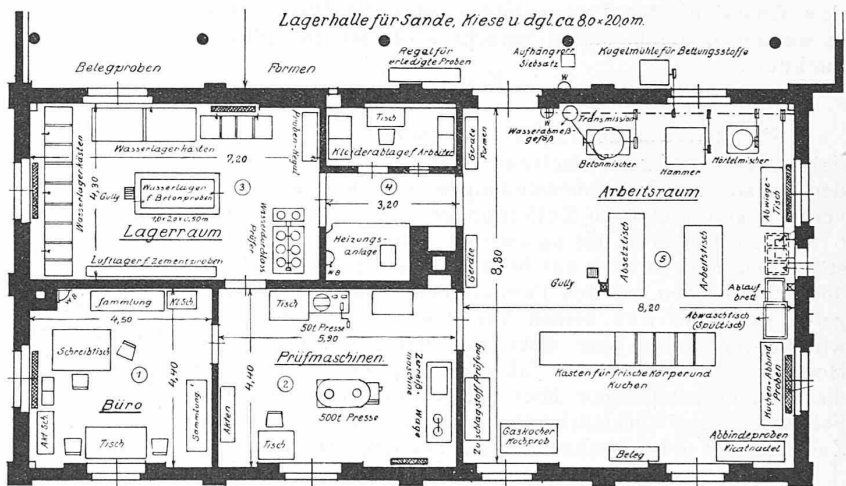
Grundriss einer Prüfstelle für Betonkontrolle. — Masstab etwa 1 : 175.
